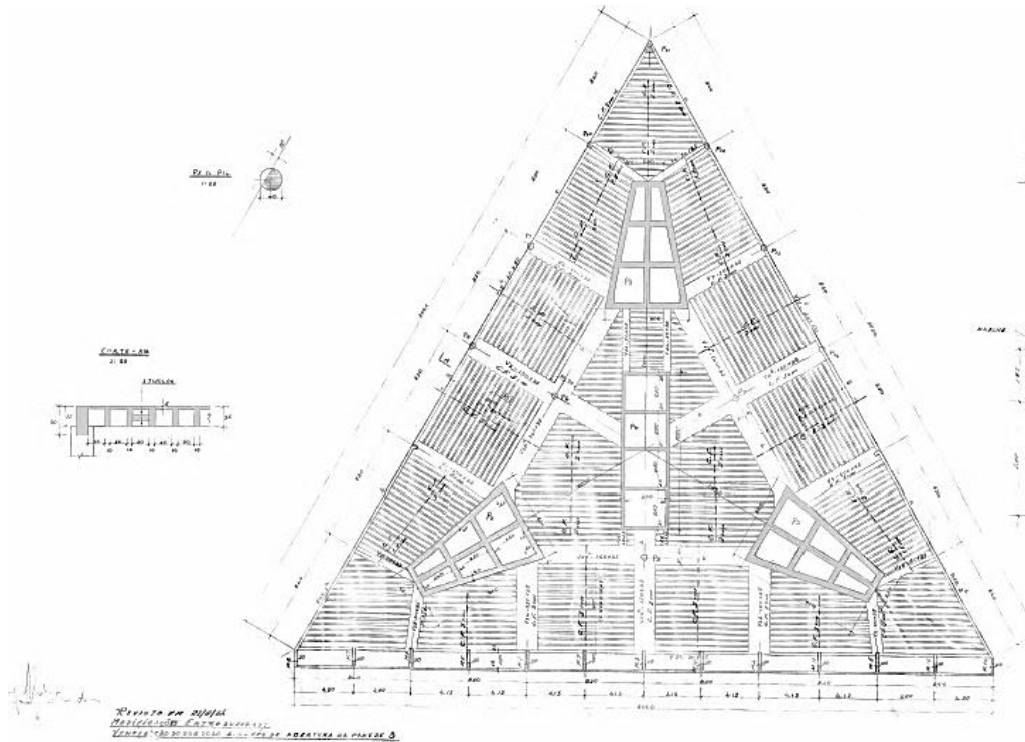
| Fôrma de piso pavimento térreo Torre de TV AZAMBUJA. A Torre de Lucio Costa em Brasília, p.72
